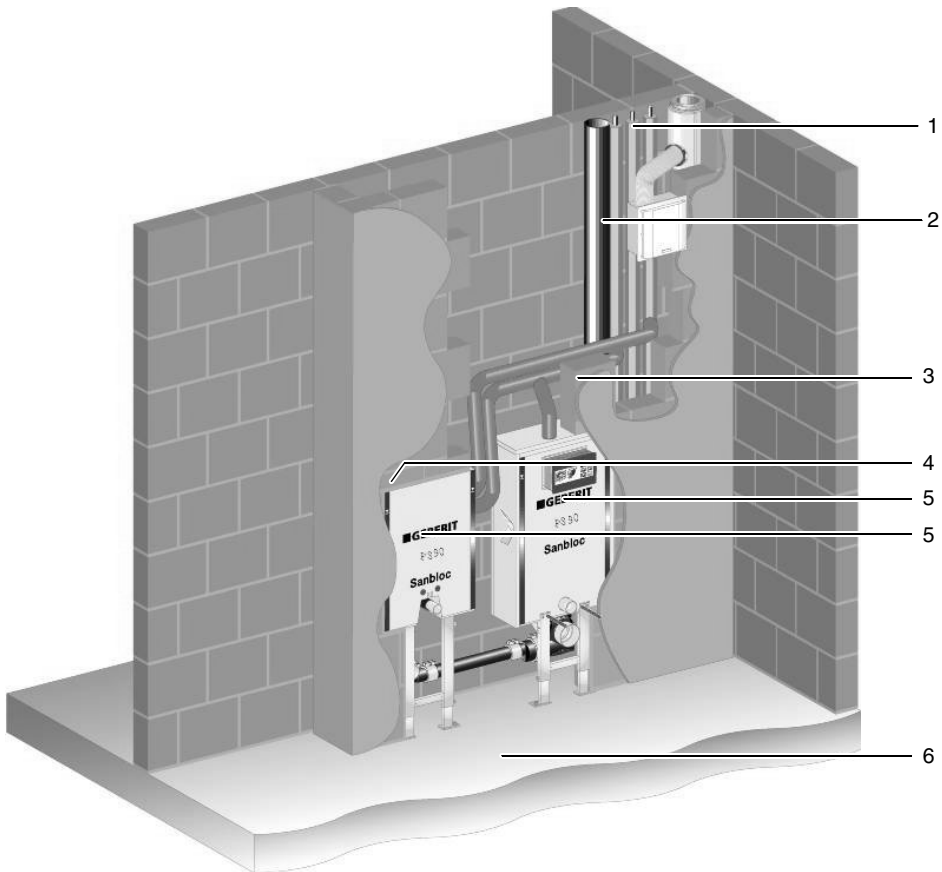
Geberit Sanbloc Installationsbaustein FS 90. Für den universellen Einbau in Schacht- oder Trennwände im Nass- und Trockenbau. Abgebildet ist die Einbausituation Nassbau.
